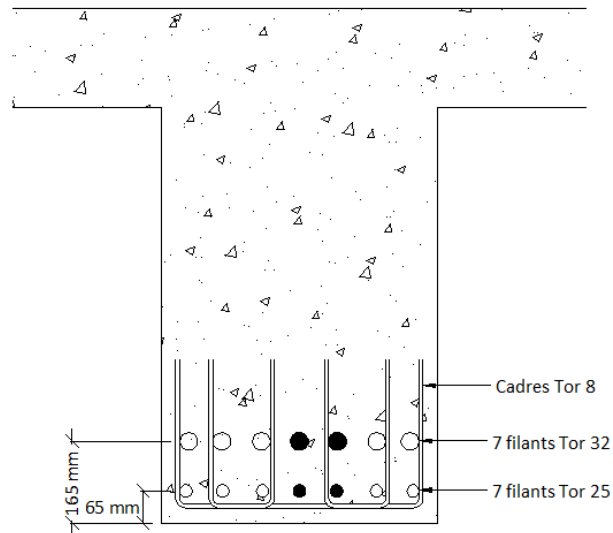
Ferrailage découvert sur la poutre Pt01 en travée 3
